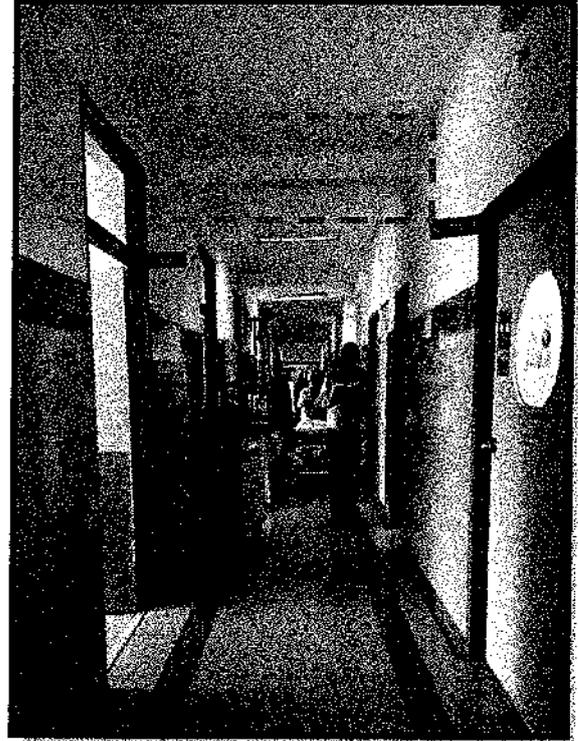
Estructuración con vigas peraltadas; pasadizo Cirugía A.
